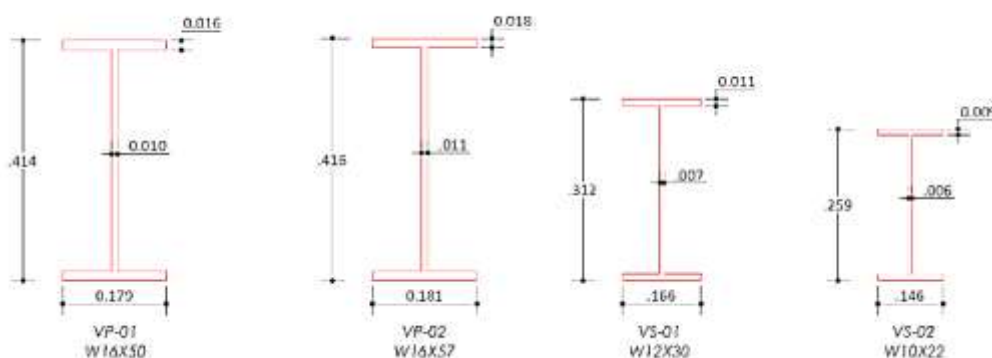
Secciones de Perfiles - Vigas Principales y Secundarias
